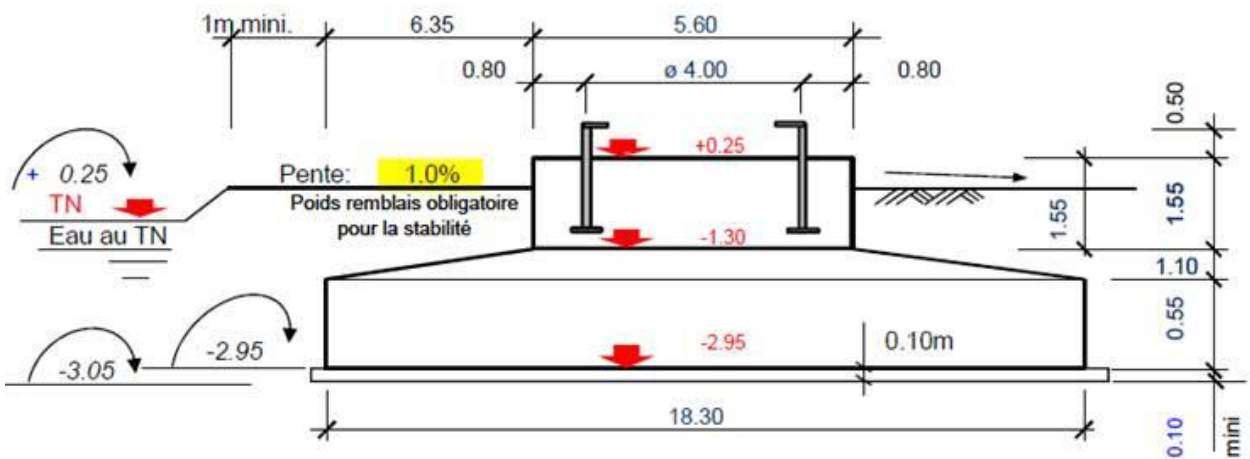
Exemple d'une coupe de fondation (source : Vestas, 2017)
